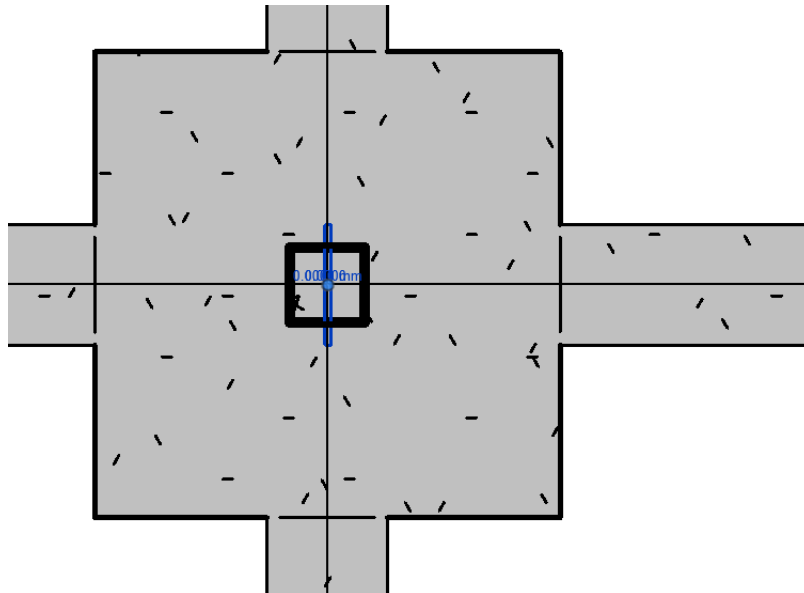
Visión en planta de una de las vigas que provocaban el warning
